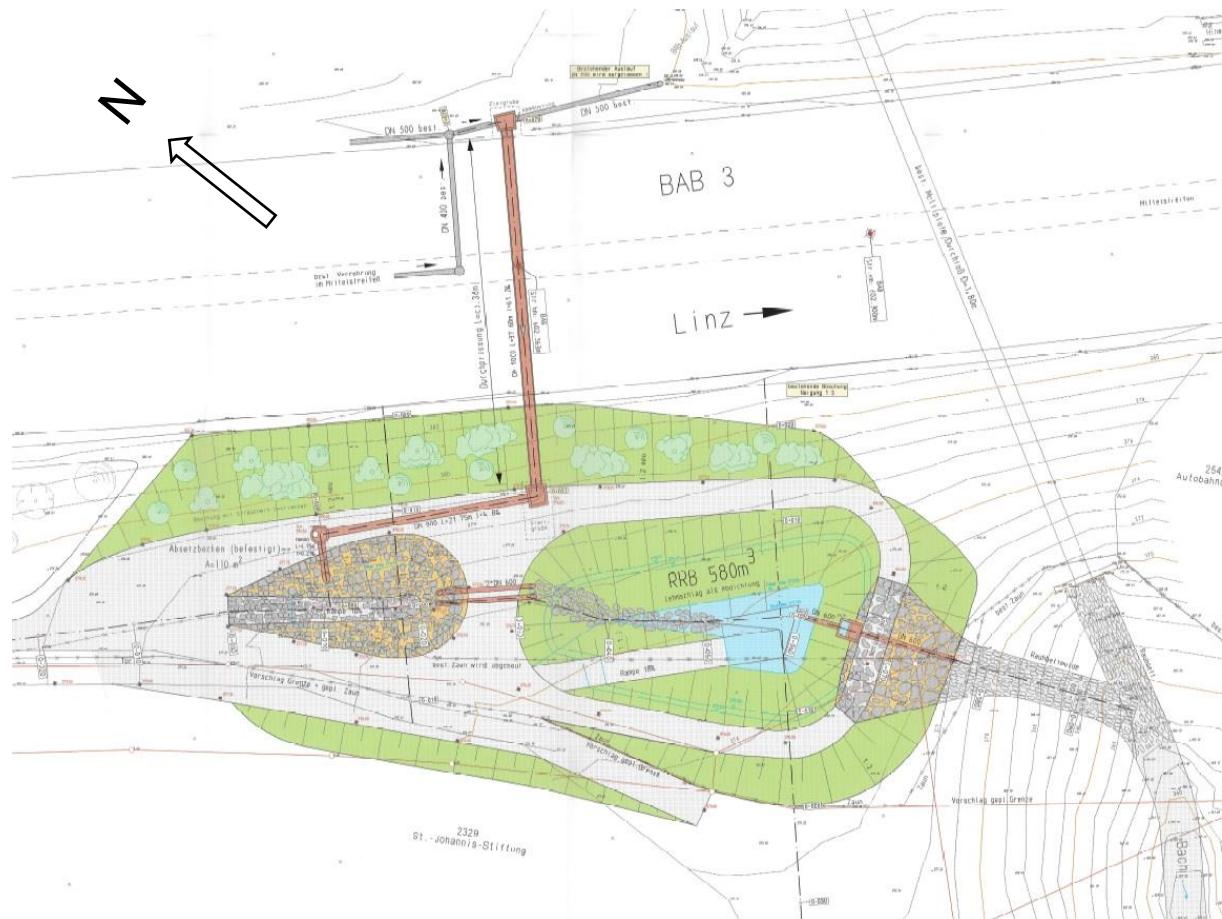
Lageplan Regenrückhalteanlage Niedernhart
